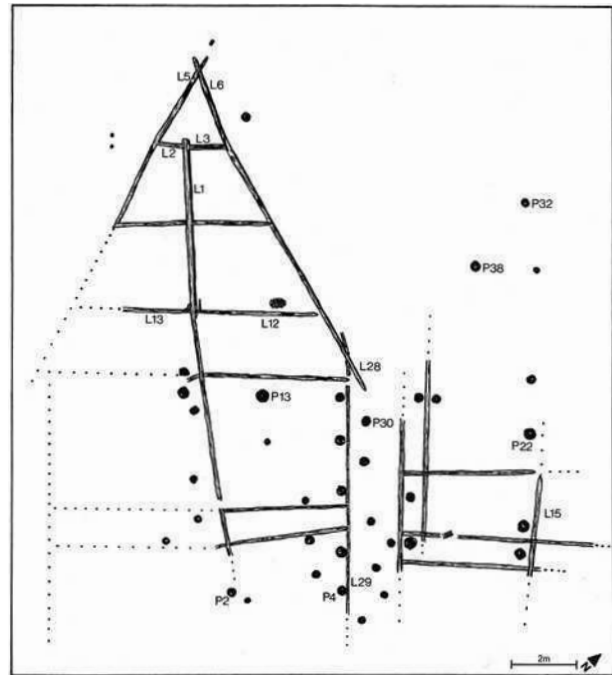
Stepperger. Grundrissplan der oberflächlich sichtbaren Holzbefunde (Pfähle, Rahmen) an Pfeiler 6. Stand 1996. Zeichnung: M. Prell/BGfU.
